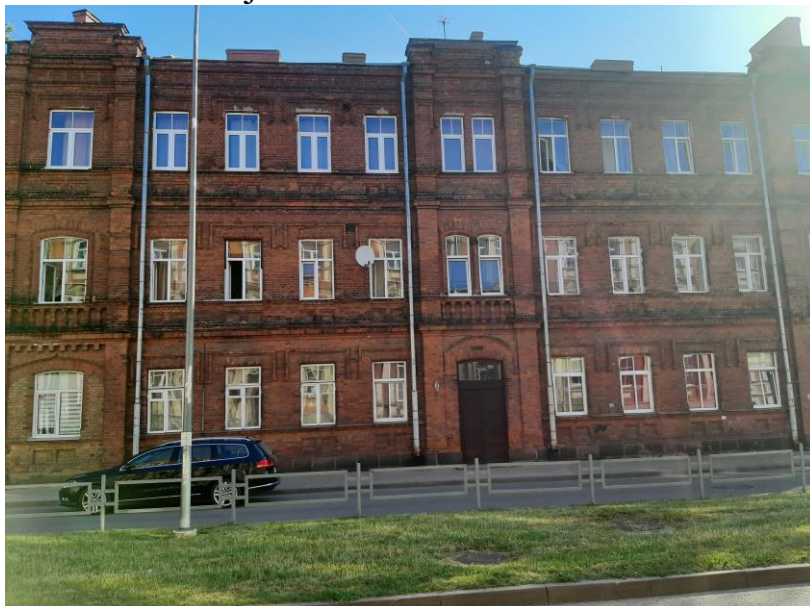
Vispārēja fotofiksācija (galvenā fasāde)
